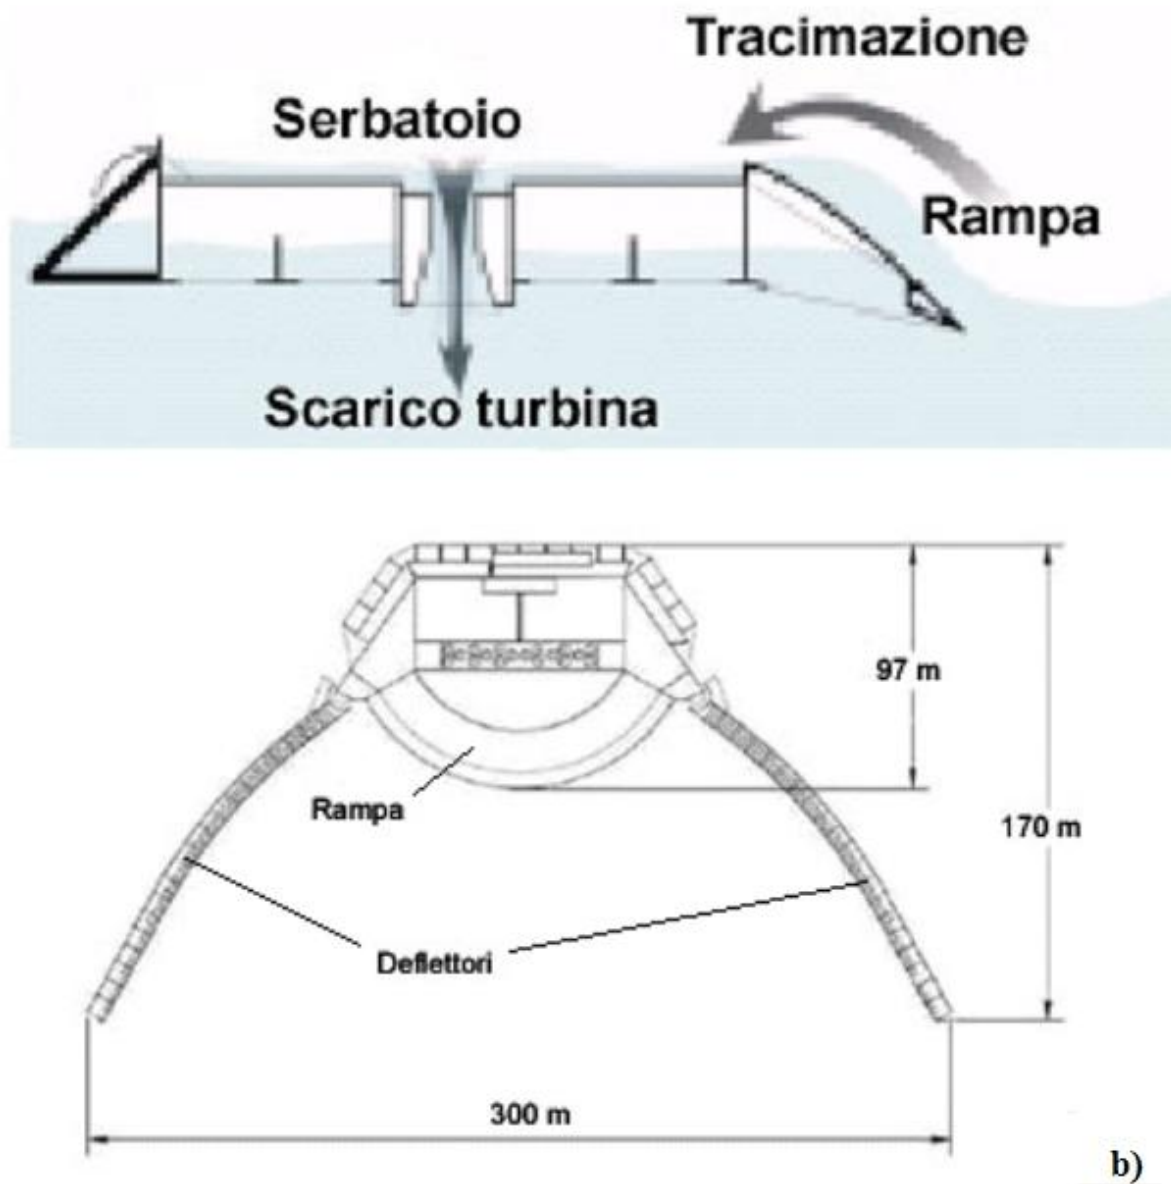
a)* Schema di funzionamento e *b)* schema planimetrico di impianto a tracimazione con concentrazione d'onde.
